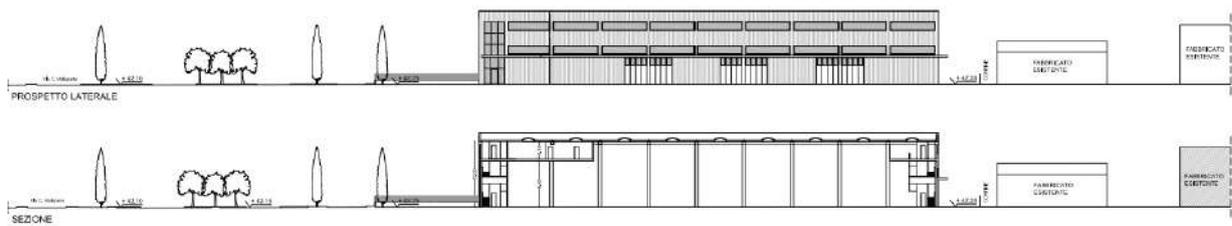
Pianta, sezione e prospetti Lotto 1 (Fonte: Tav. E8 Lotto 1 del Piano Attuativo PMU 4.4)
